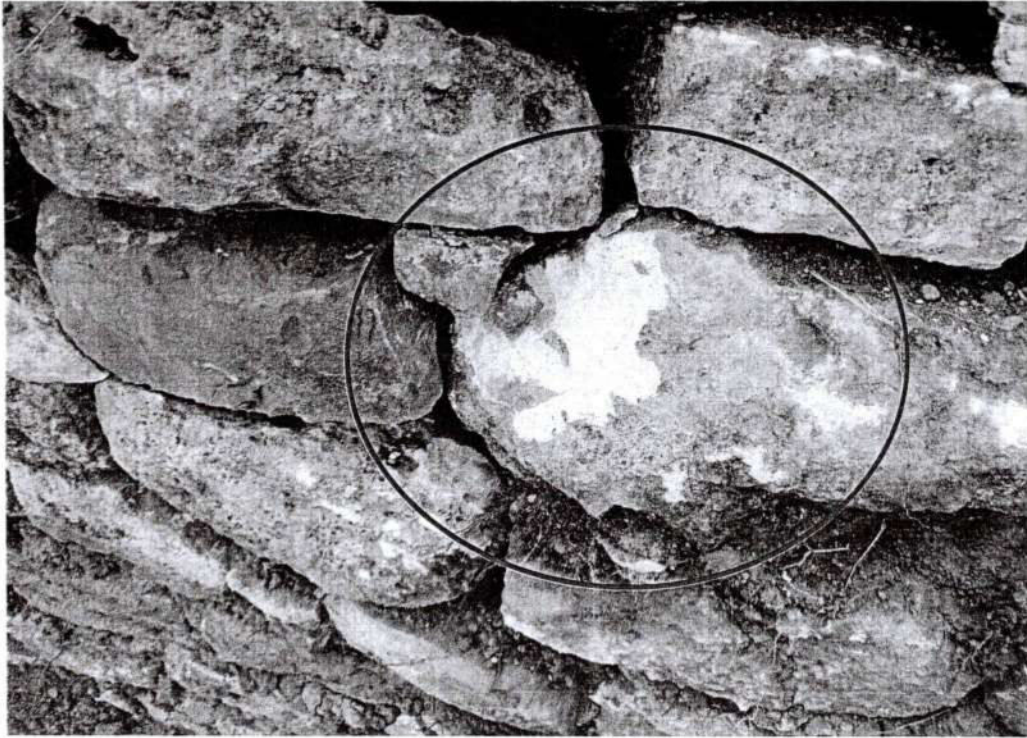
Vista de la estructura forma semicircular donde se evidencia la fractura que sufrió algunas piedras del muro. (inspección técnica 20/08/2024).
